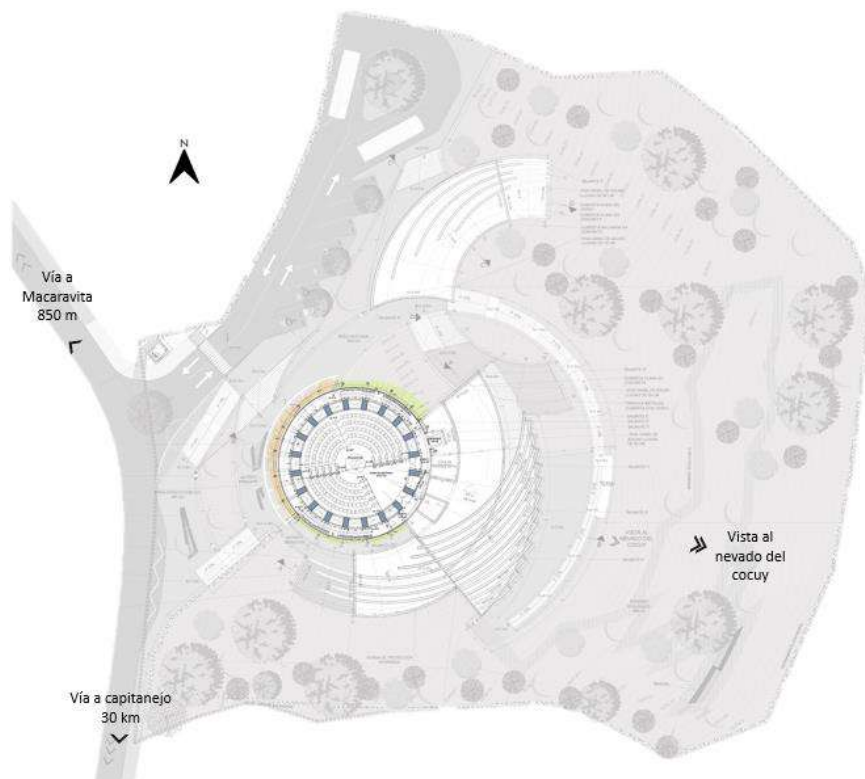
Planta nivel +5.5 edificio Sur, Domo de proyecciones
